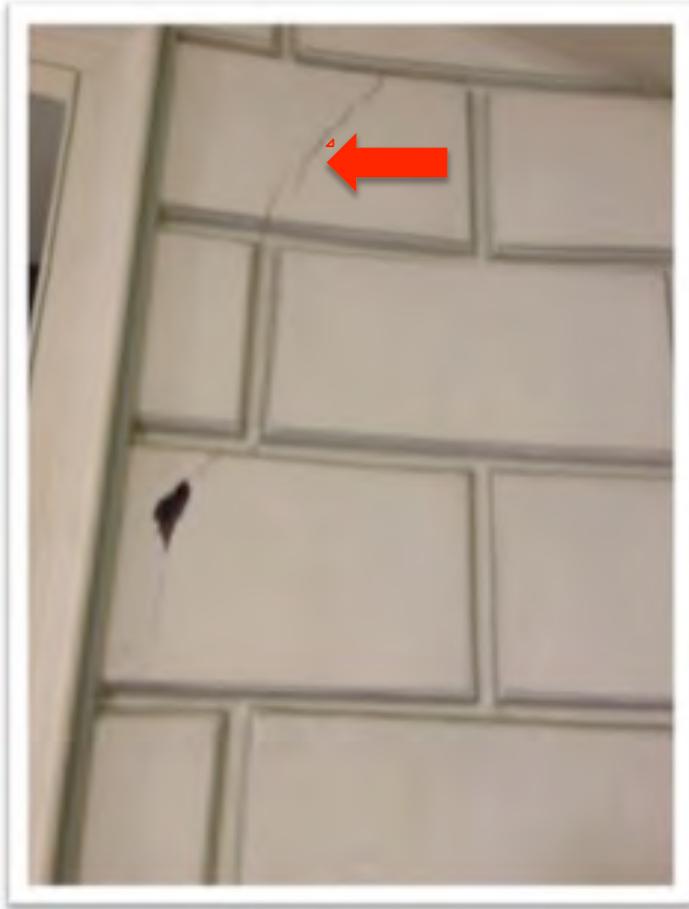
Grietas y pérdida de sección en escalera.
